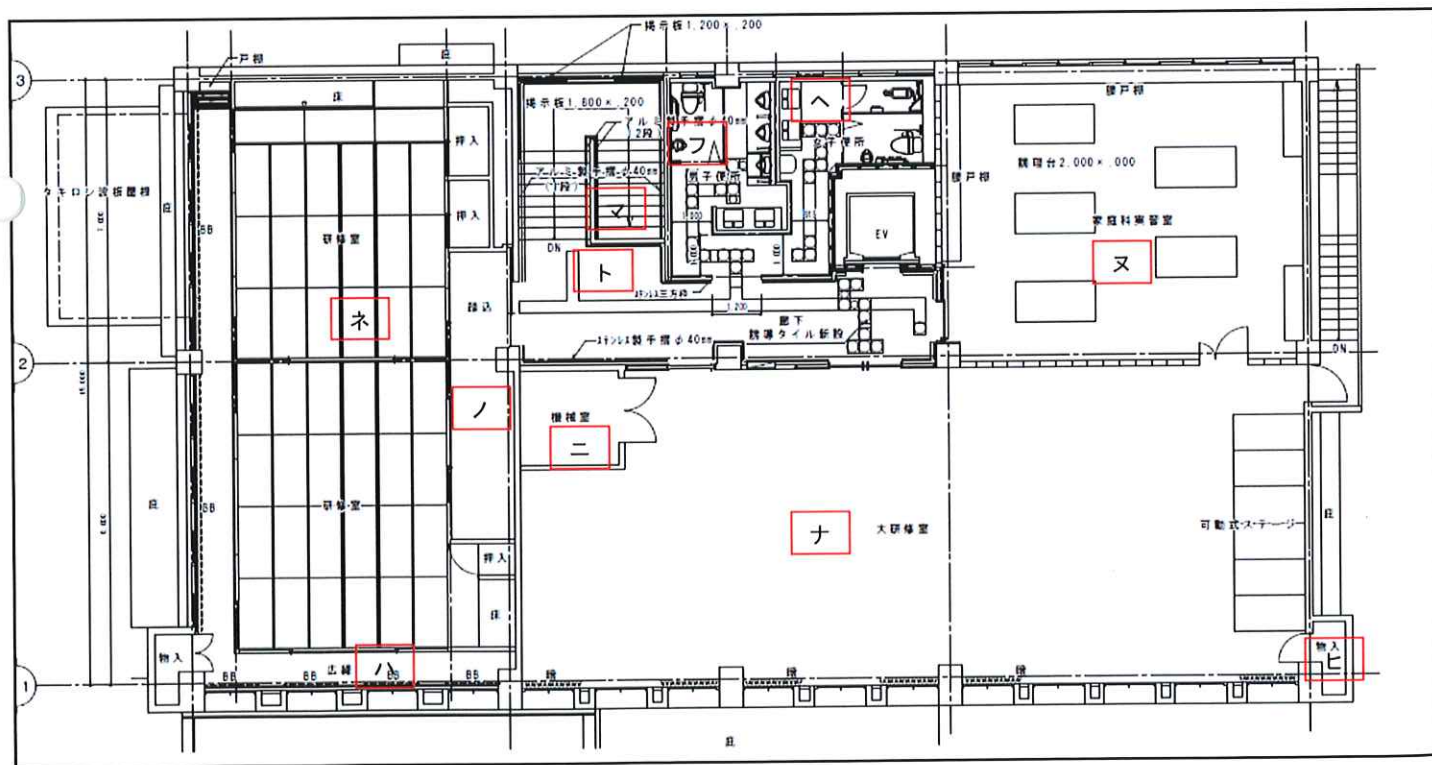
(2) 旧幸袋交流センター平面図 (2 階)
